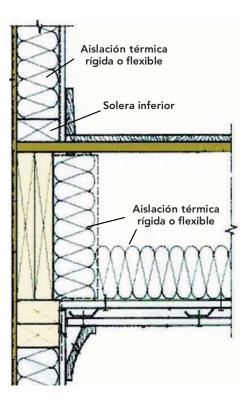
13: Aislación de viga perimetral, y entrepiso segundo nivel.
